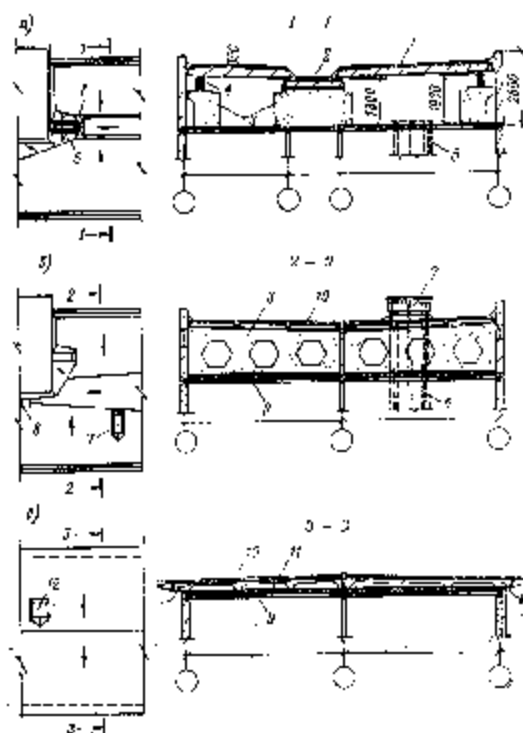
Виды покрытий*; а – плоская, с теплым чердаком, б – плоское, с холодным чердаком, в – плоское, совмещенное, вентилируемое; 1 – кровельные панели из конструктивного керамзитобетона, 2 – лотковая керамзитобетонная панель, 3 – железобетонные стенки, 4 – продольный железобетонный ригель, 5 – вентиляционный блок, 6 – вентиляционная шахта, 7 – вентиляционная труба, 8 – внутренний водосток, 9 – утеплитель, 10 – ребристый настил, 11 – вентилируемая воздушная прослойка, 12 – лаз на крышу.
